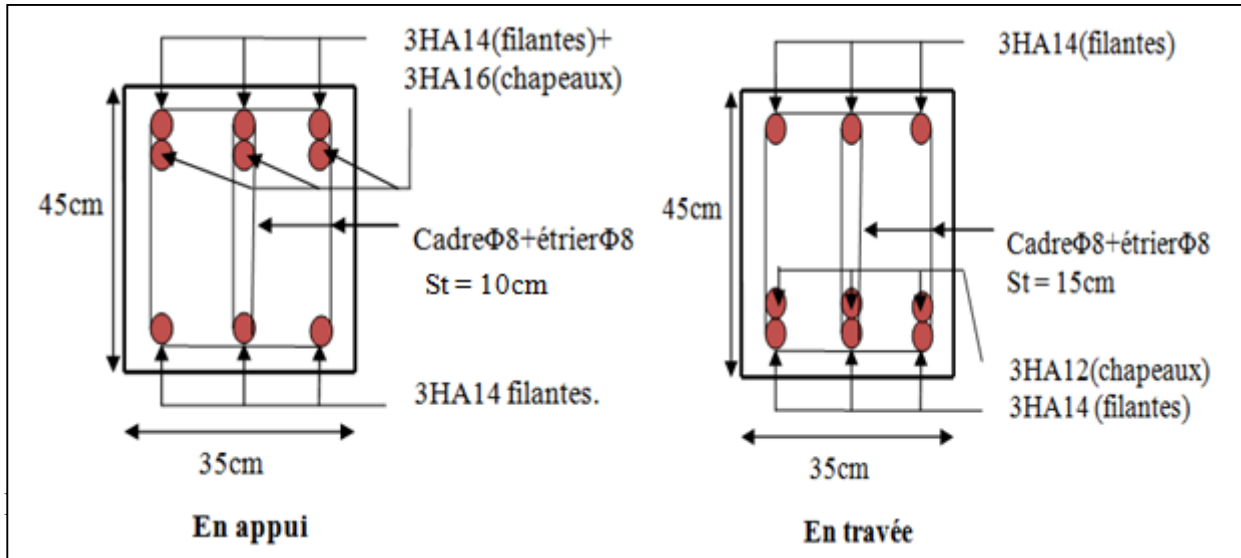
Exemple de Schéma de ferrailage d'une poutre principale.
